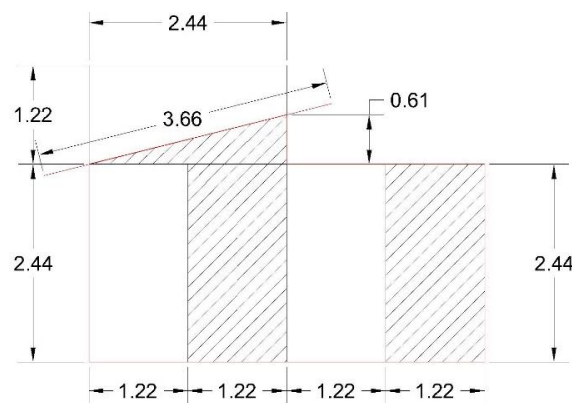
Alzado Frontal y dimensiones de modulo tipo (esquema elaborado por el autor)
